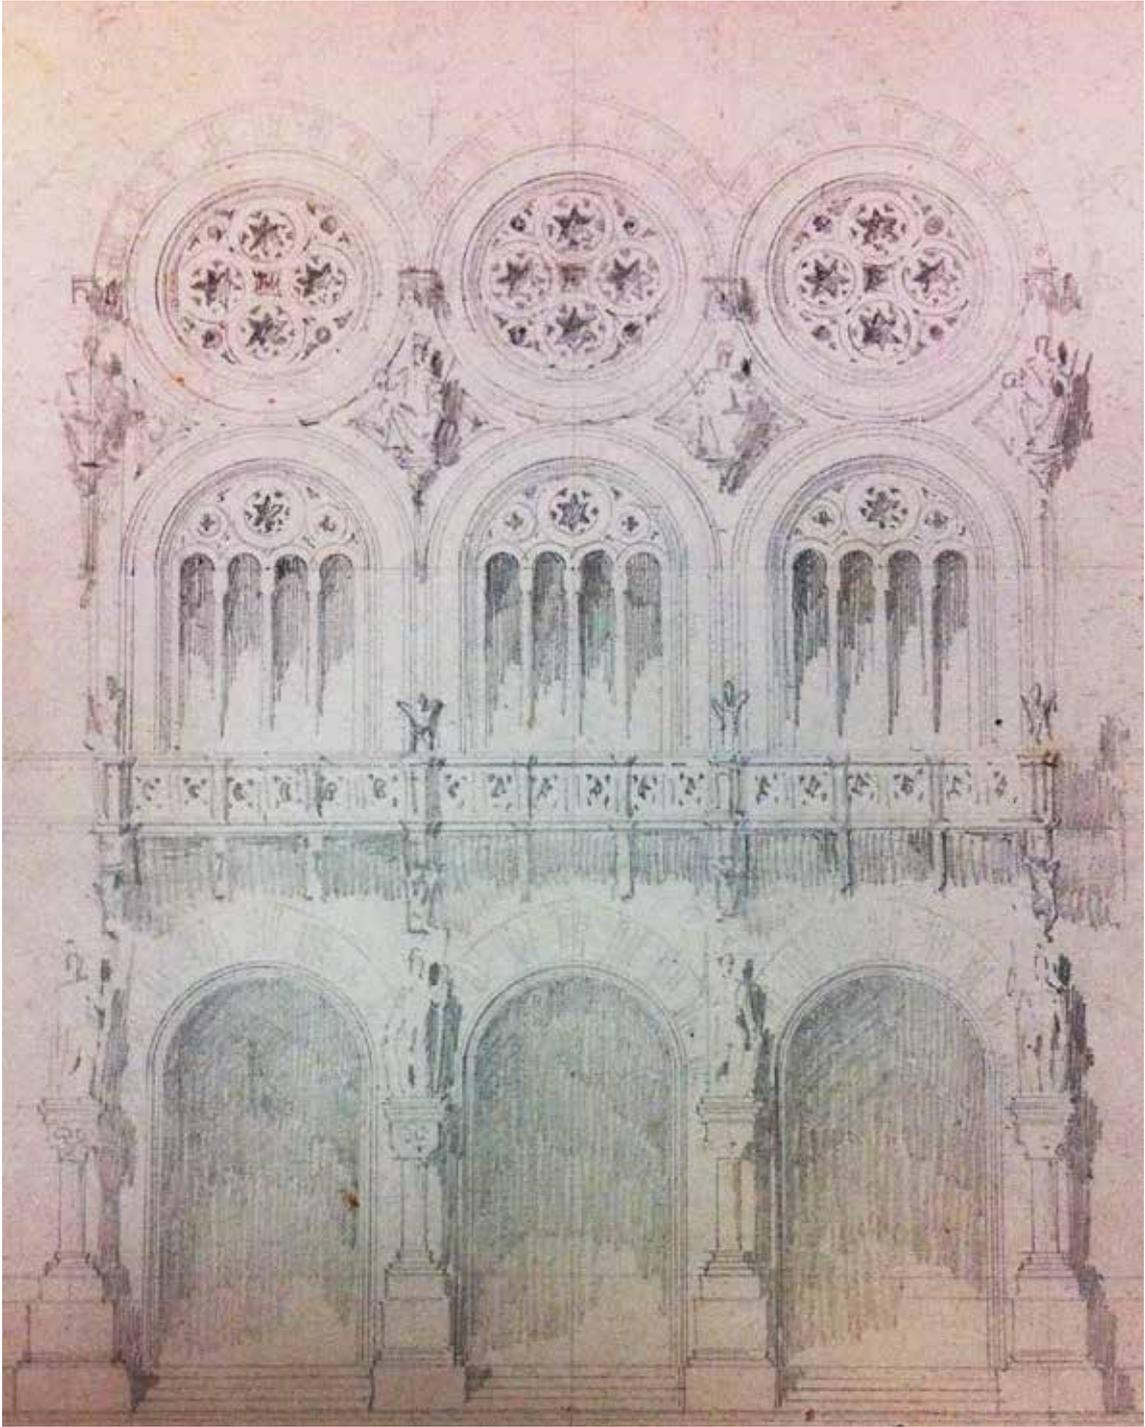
, Fassadenaufriss des Waffenmuseums, Entwurfszeichnung, Ausschnitt
